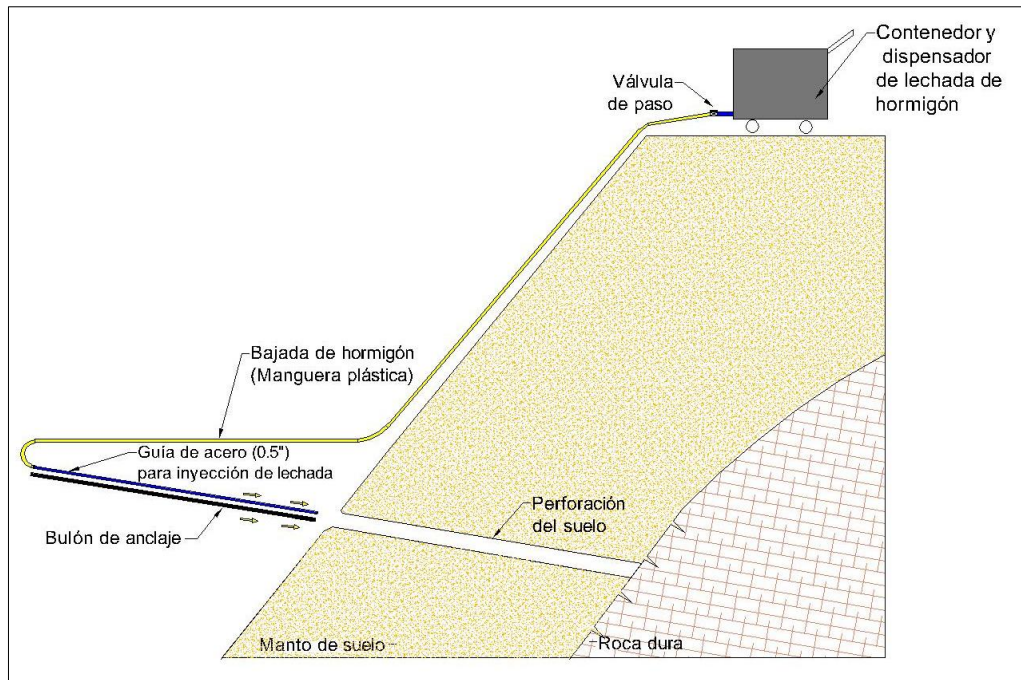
Propuesta de sistema de inyección por gravedad de hormigón para MCC
